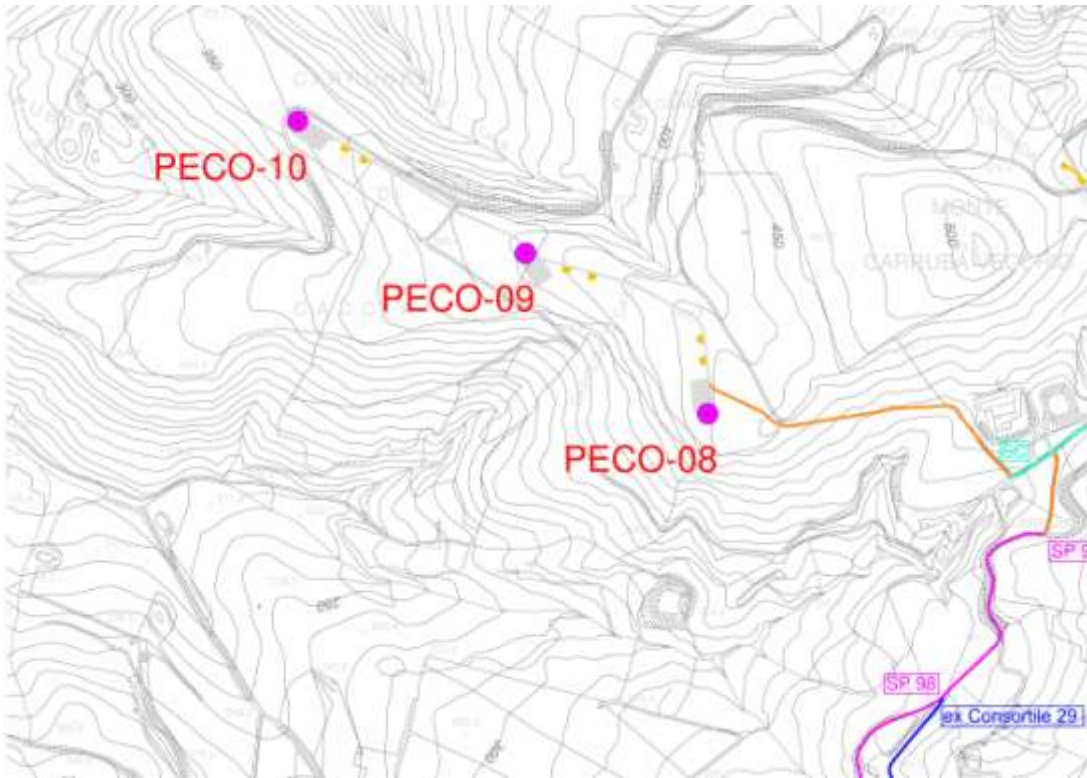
, 6.5, 6.6, 6.7- Stralci planimetrici delle strade di cantiere
